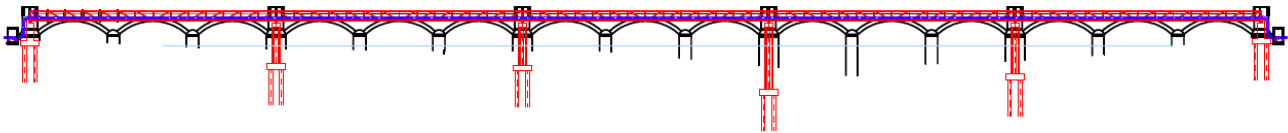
Sezione longitudinale attraversamento aereo di progetto sul Fiume Sangro.
